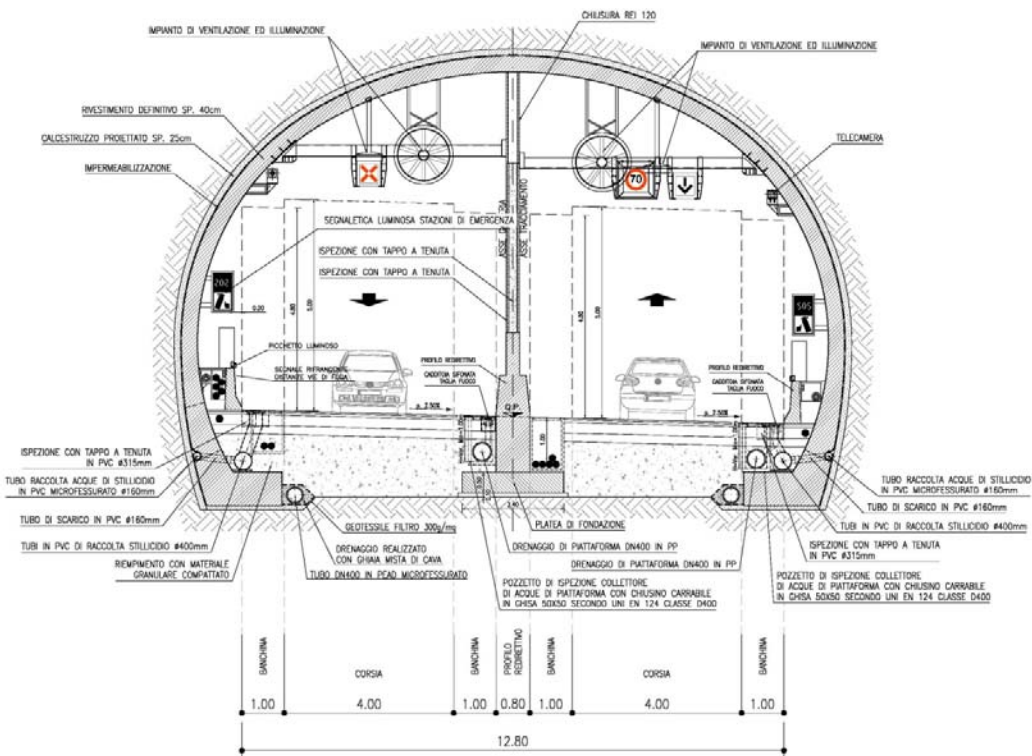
Sezione tipo gallerie Caravaggio e Fontanabuona
